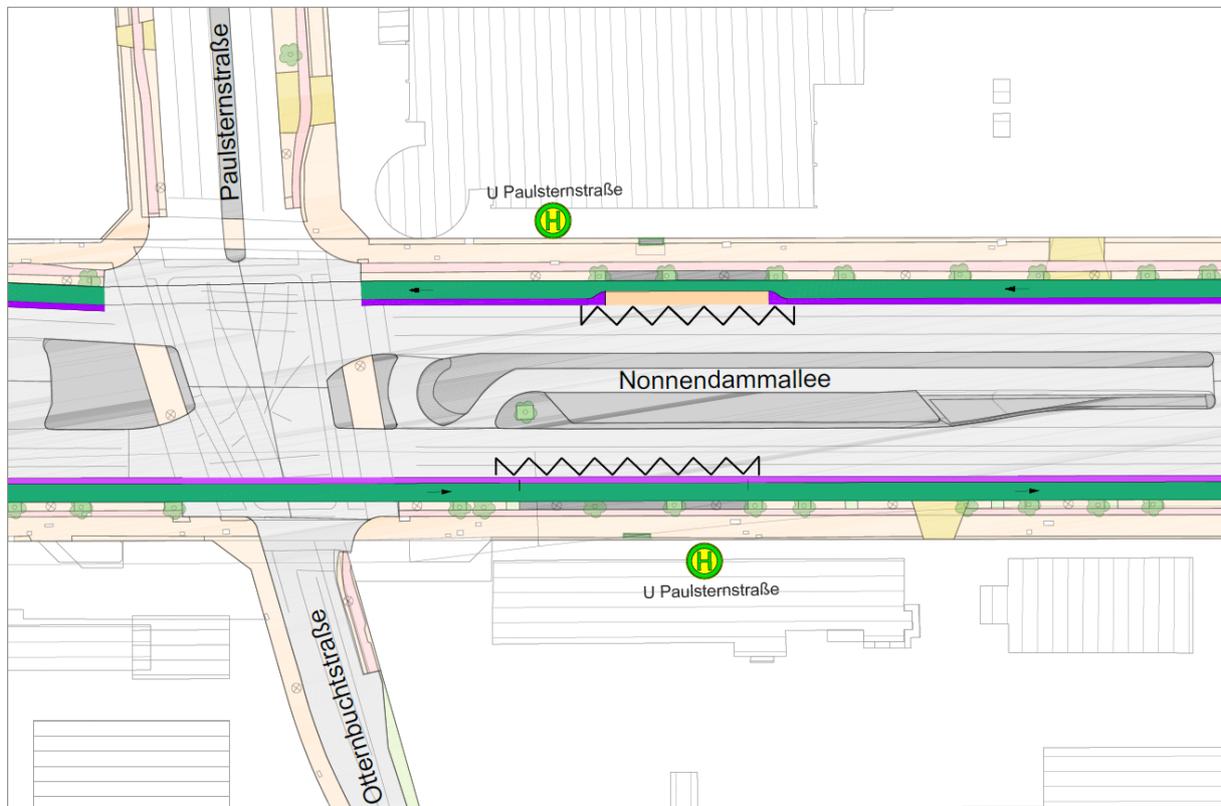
Nonnendammallee/U-Bhf. Paulsternstraße – Ausschnitt Lageplan
